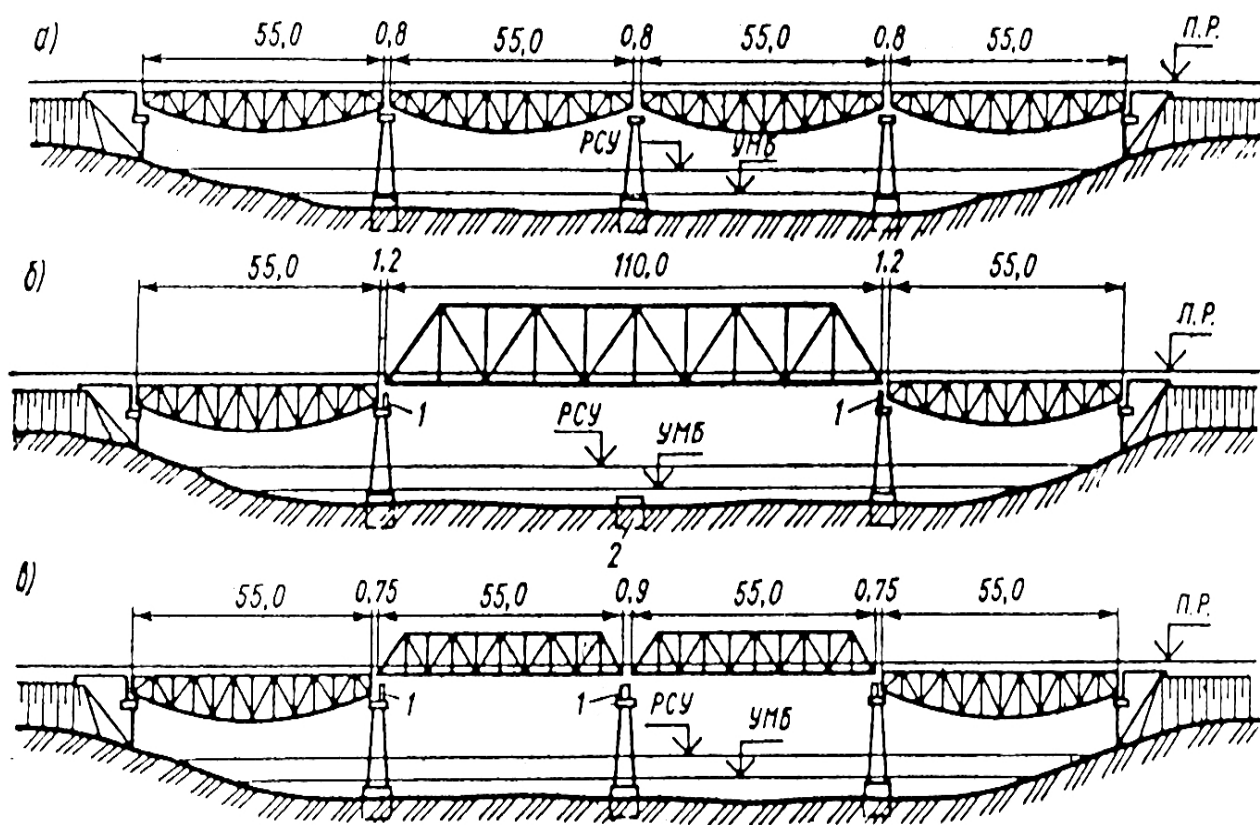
Схемы увеличения подмостового габарита моста:
